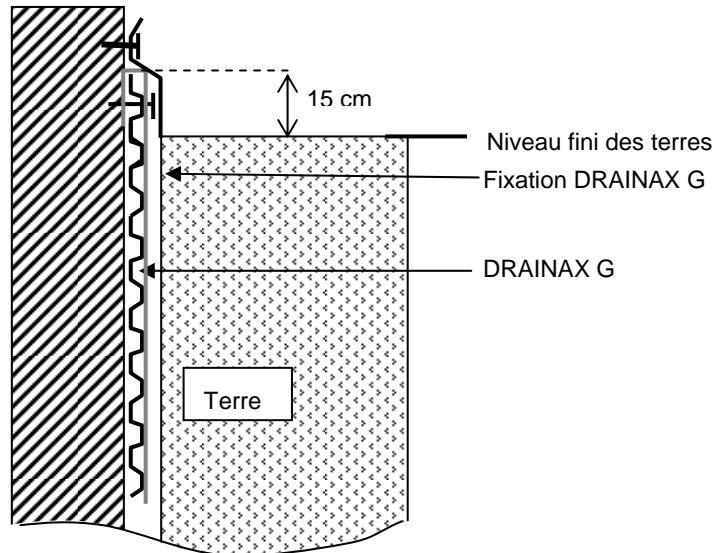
Arrêt supérieur du DRAINAX G sur support nu, enduit ou revêtement d'étanchéité
